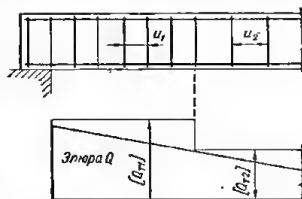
К определению границы между участками с различной интенсивностью поперечного армирования при расчете балки по раскрытию трещин.
